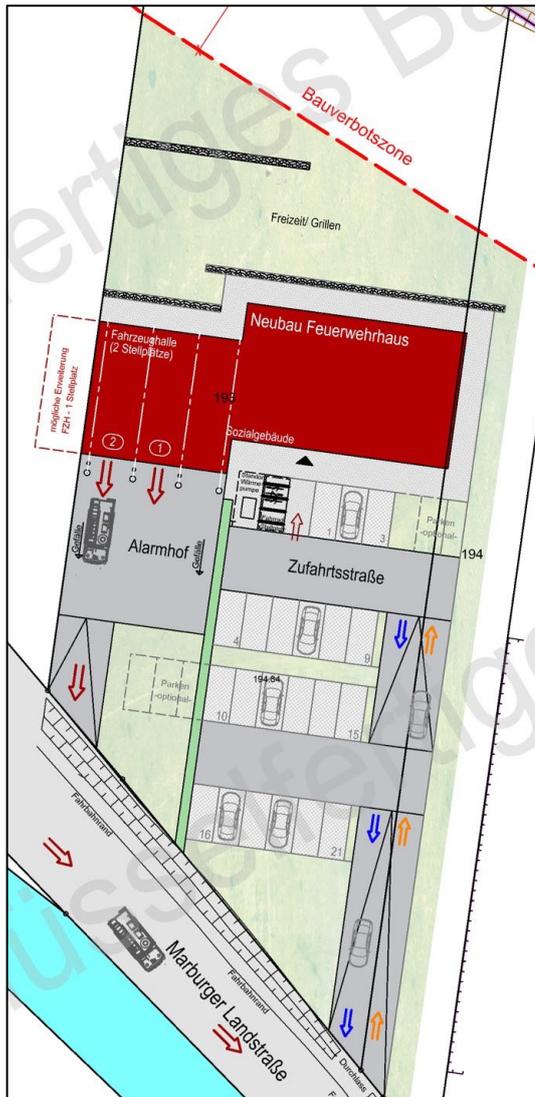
Lageplan Feuerwehrgerätehaus - BauTec, Burbach, 10/2022
